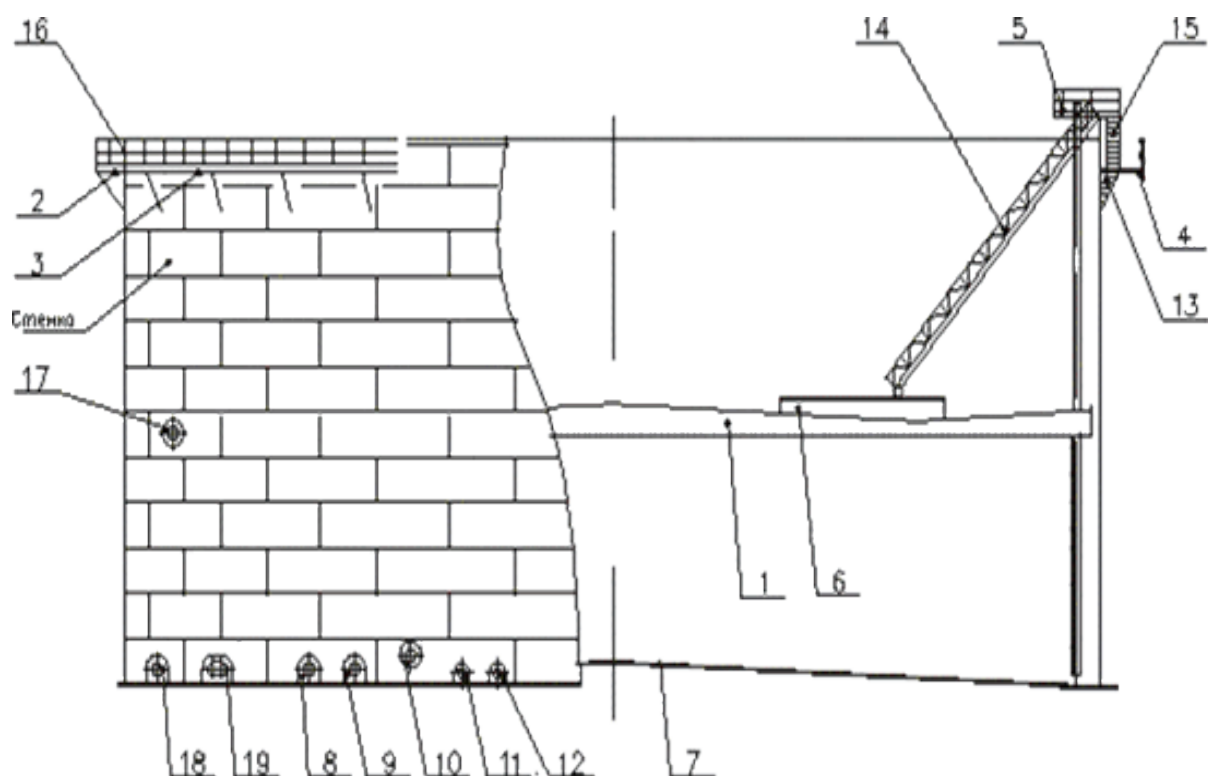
Цилиндрический сварной стальной резервуар с плавающей крышей и кольцевой лестницей:
